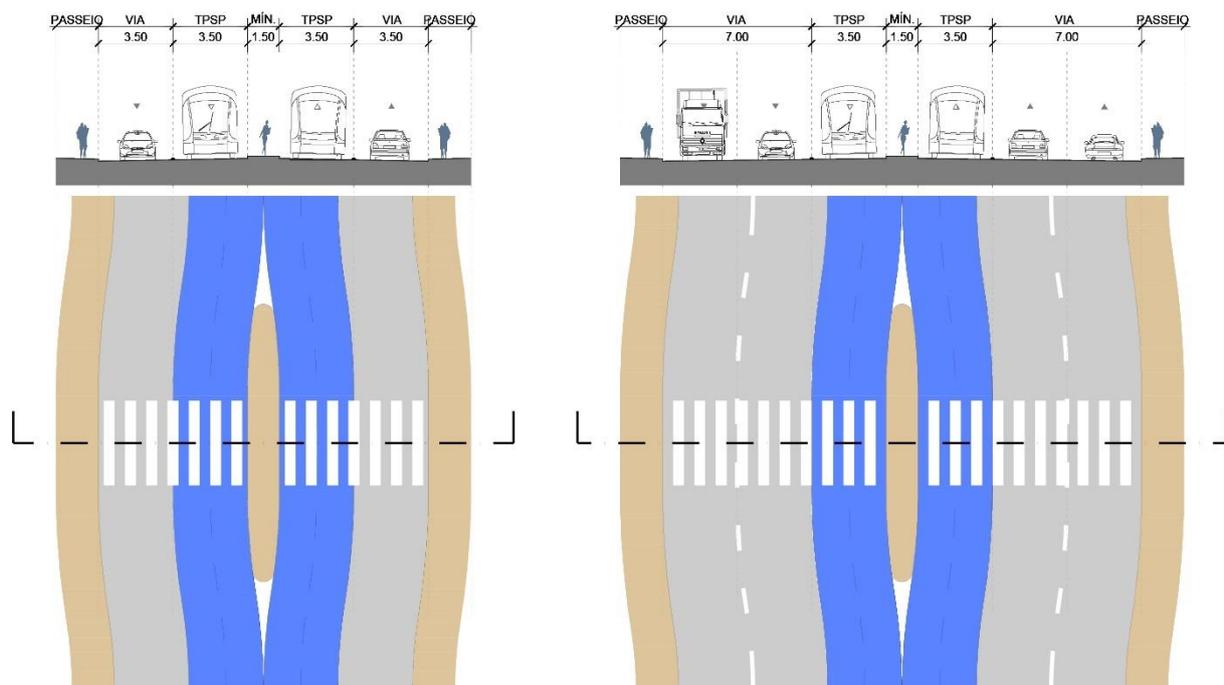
| Pormenor da solução de traçado proposta das zonas de passadeira, nos troços em que o perfil transversal tem, pelo menos, 4 vias de circulação
